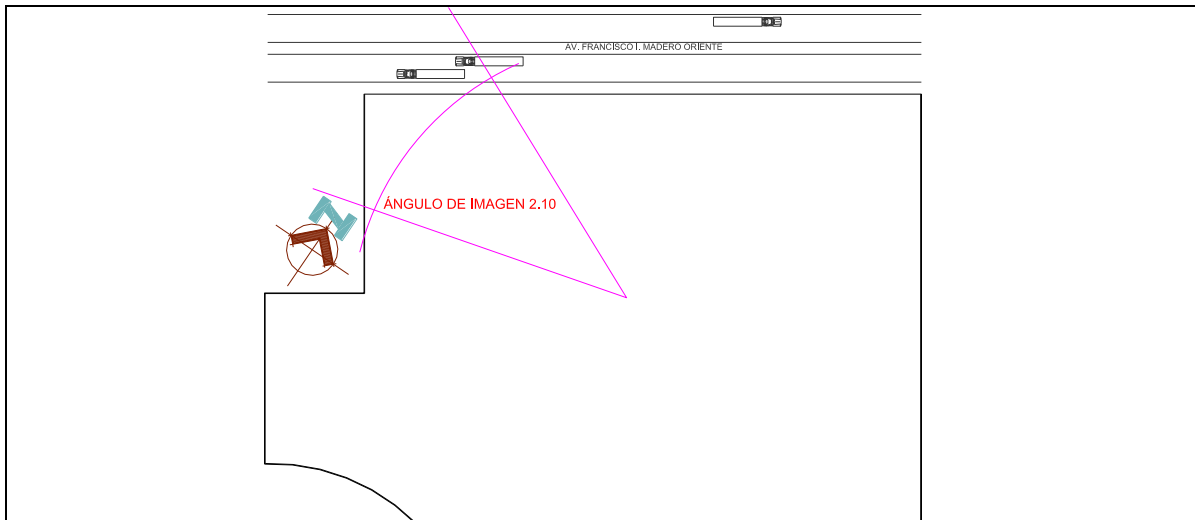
, Plano de ubicación de enfoque de cámara, vista Poniente. Fuente: Elaborada por el autor.
